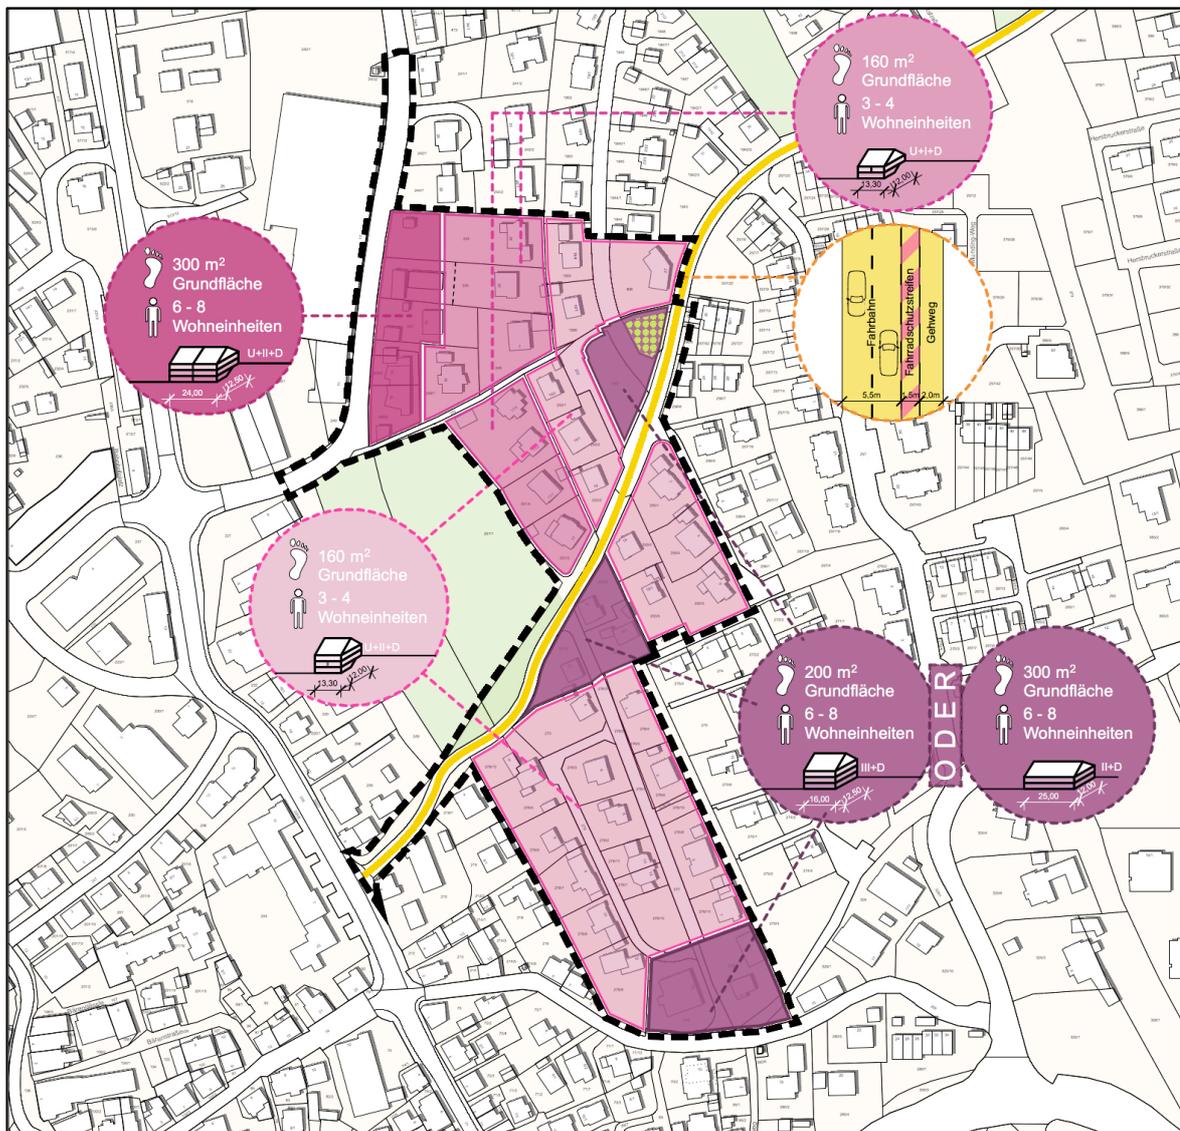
Rahmenplanalternative 3, Plan Nr. 14.3
